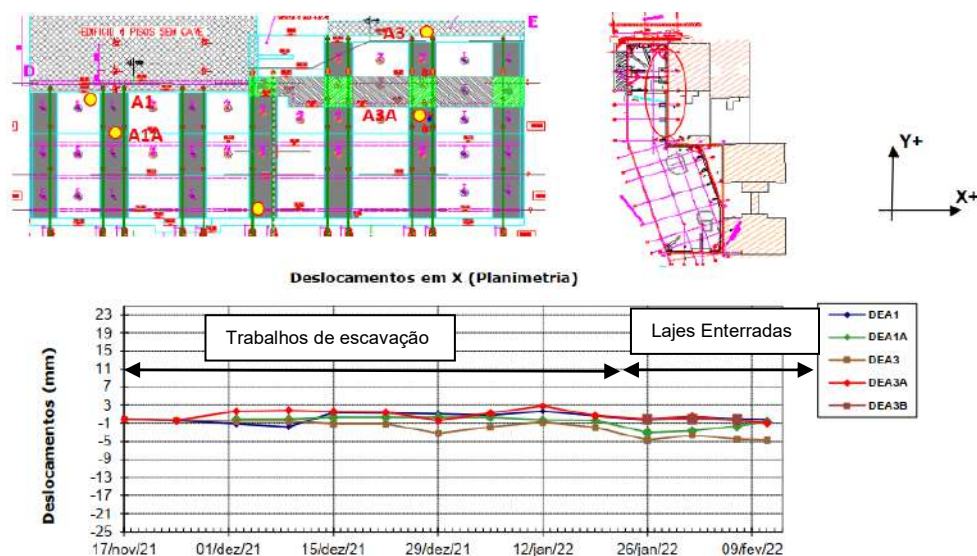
Deslocamento para fora do plano – Muros - zona de maior escavação
